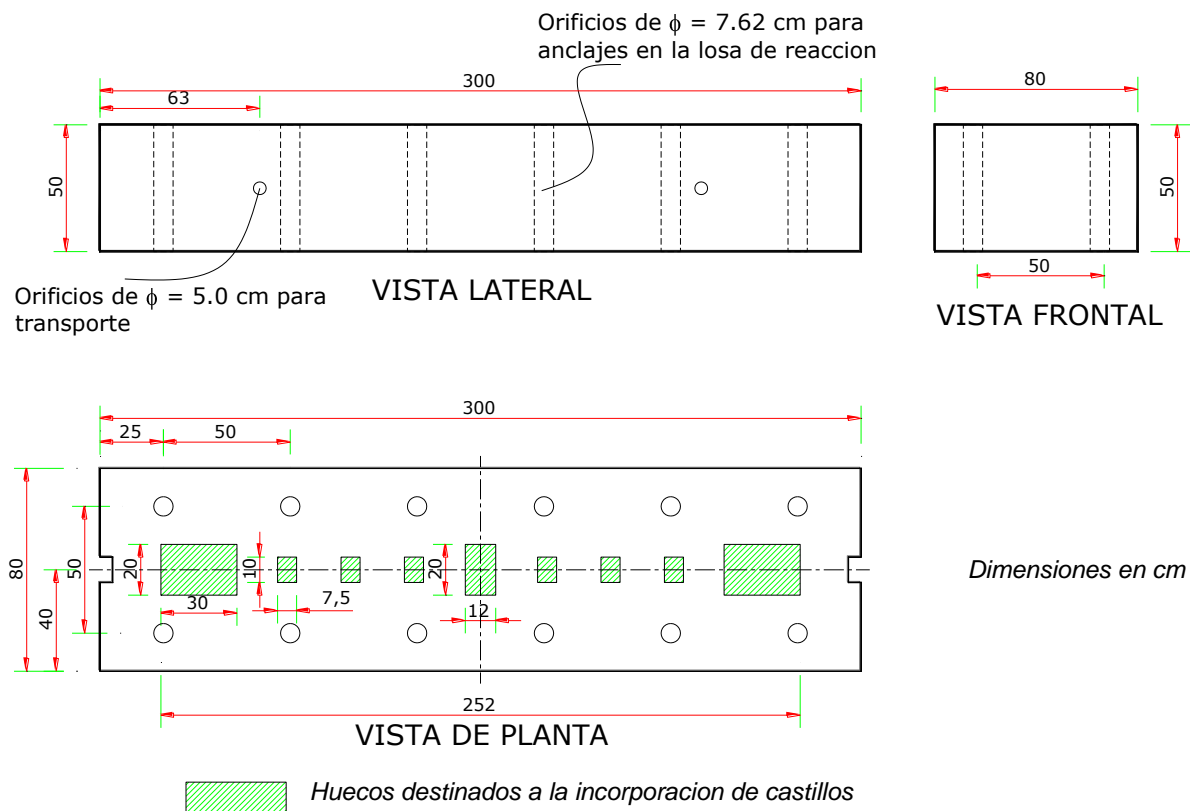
Geometría de la viga de cimentación, con la posición de los huecos para la incorporación de los elementos de los muros de mampostería.
